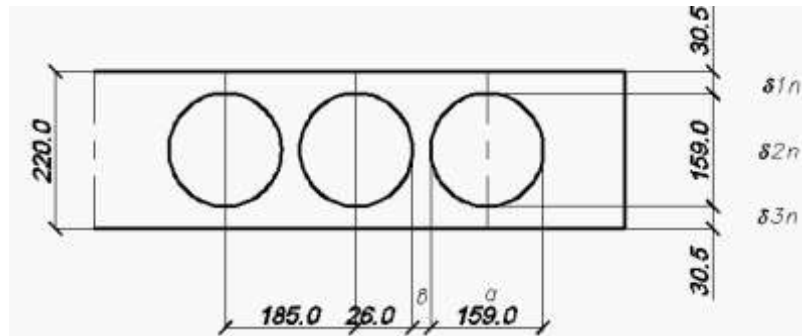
Расчетная схема пустотной железобетонной плиты
